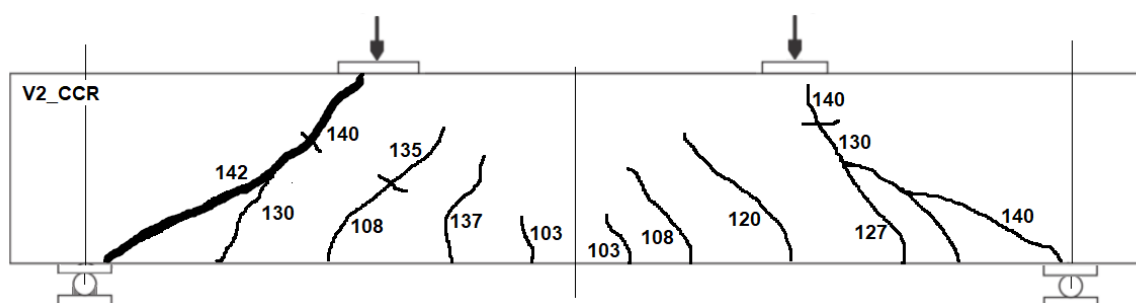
Esquema de fissuração da Viga 2_CCR.
